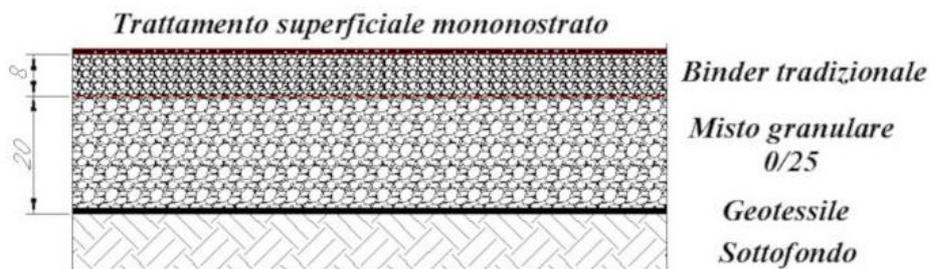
Particolare pavimentazione della pista ciclo-pedonale.
